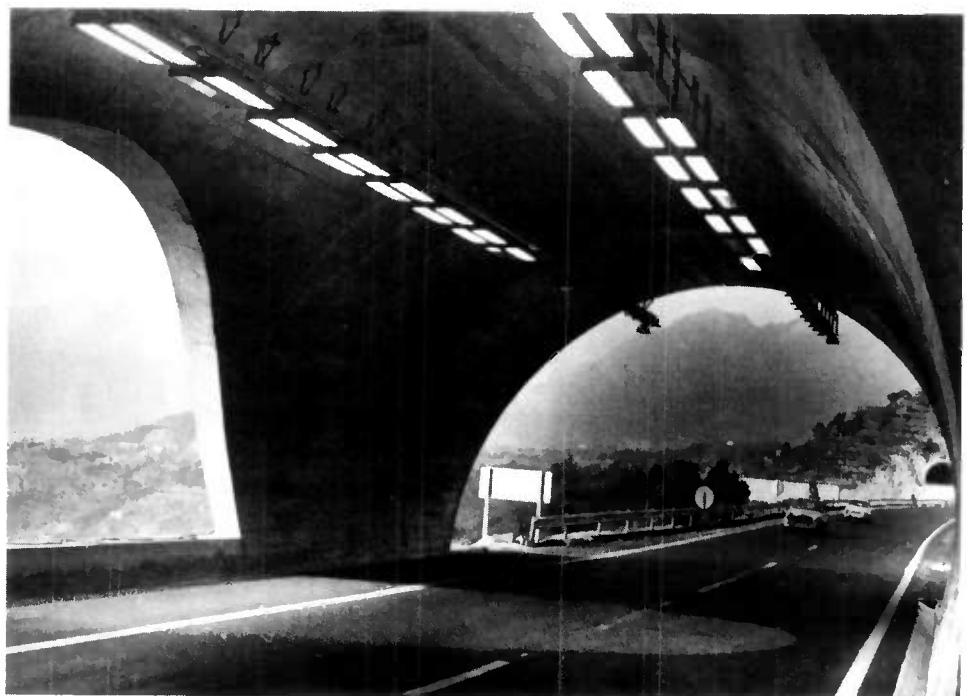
Autoroute A 8 - Tunnel de la Girarde.
